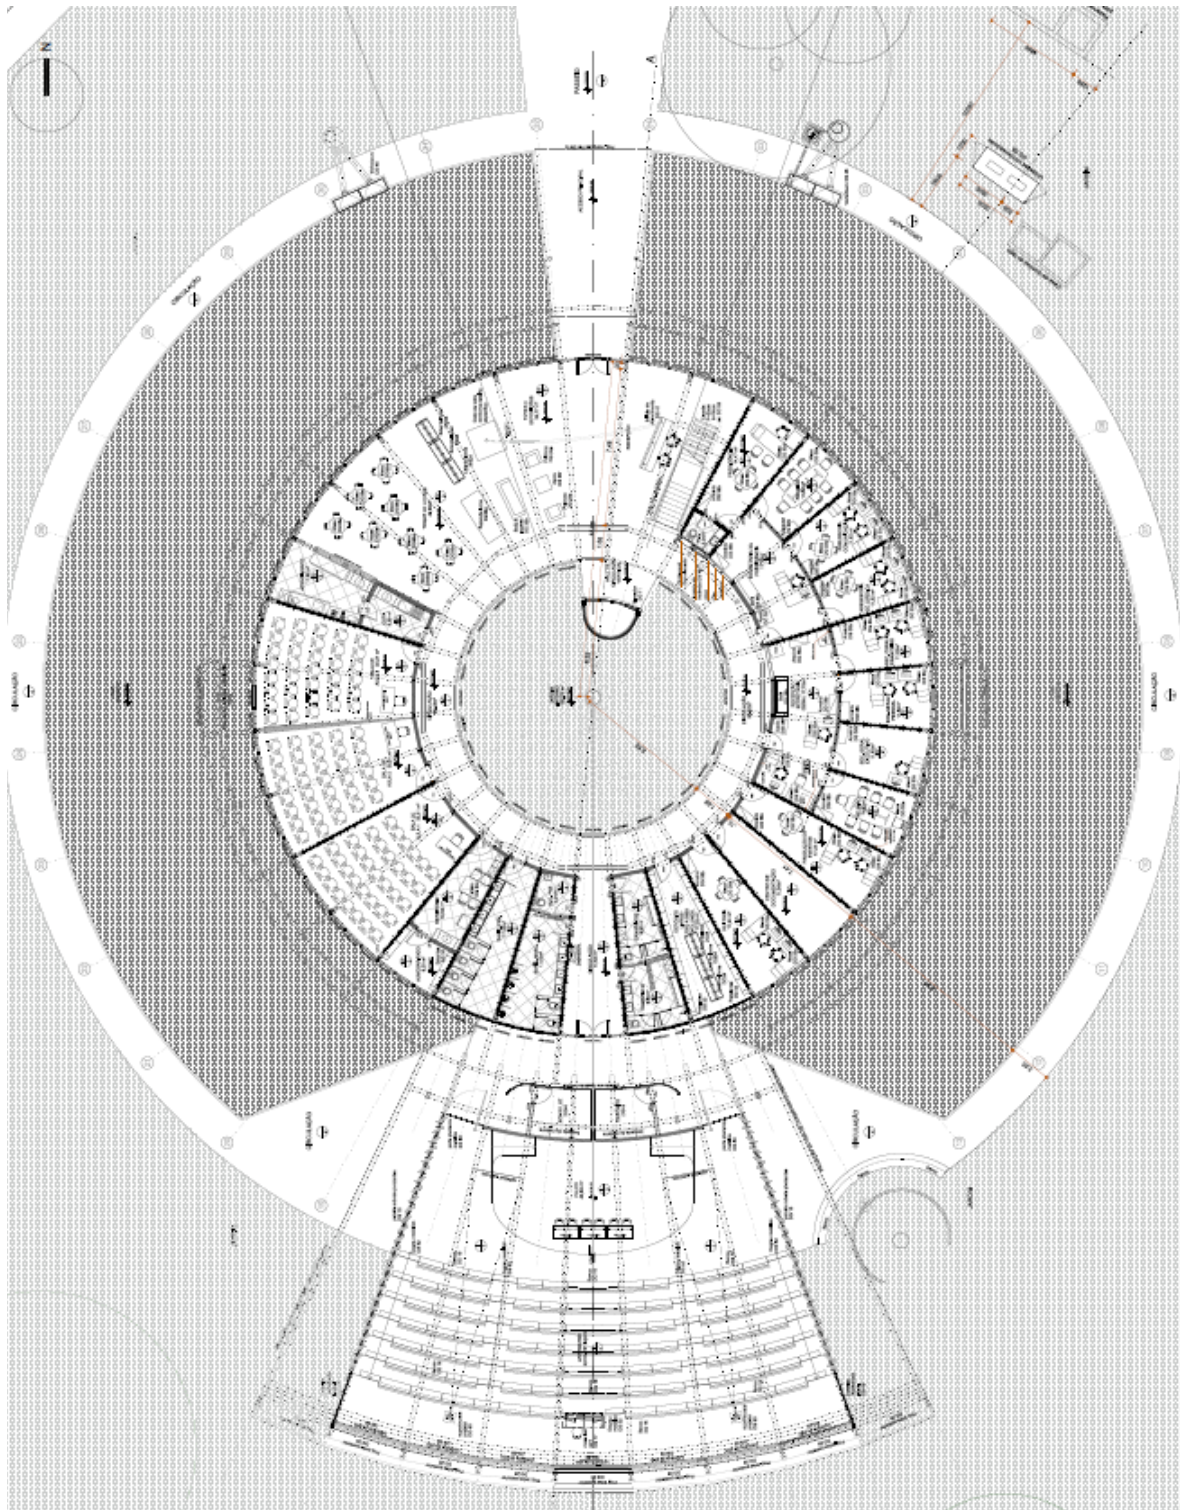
Pavimento Térreo da Fundação Darcy Ribeiro.
